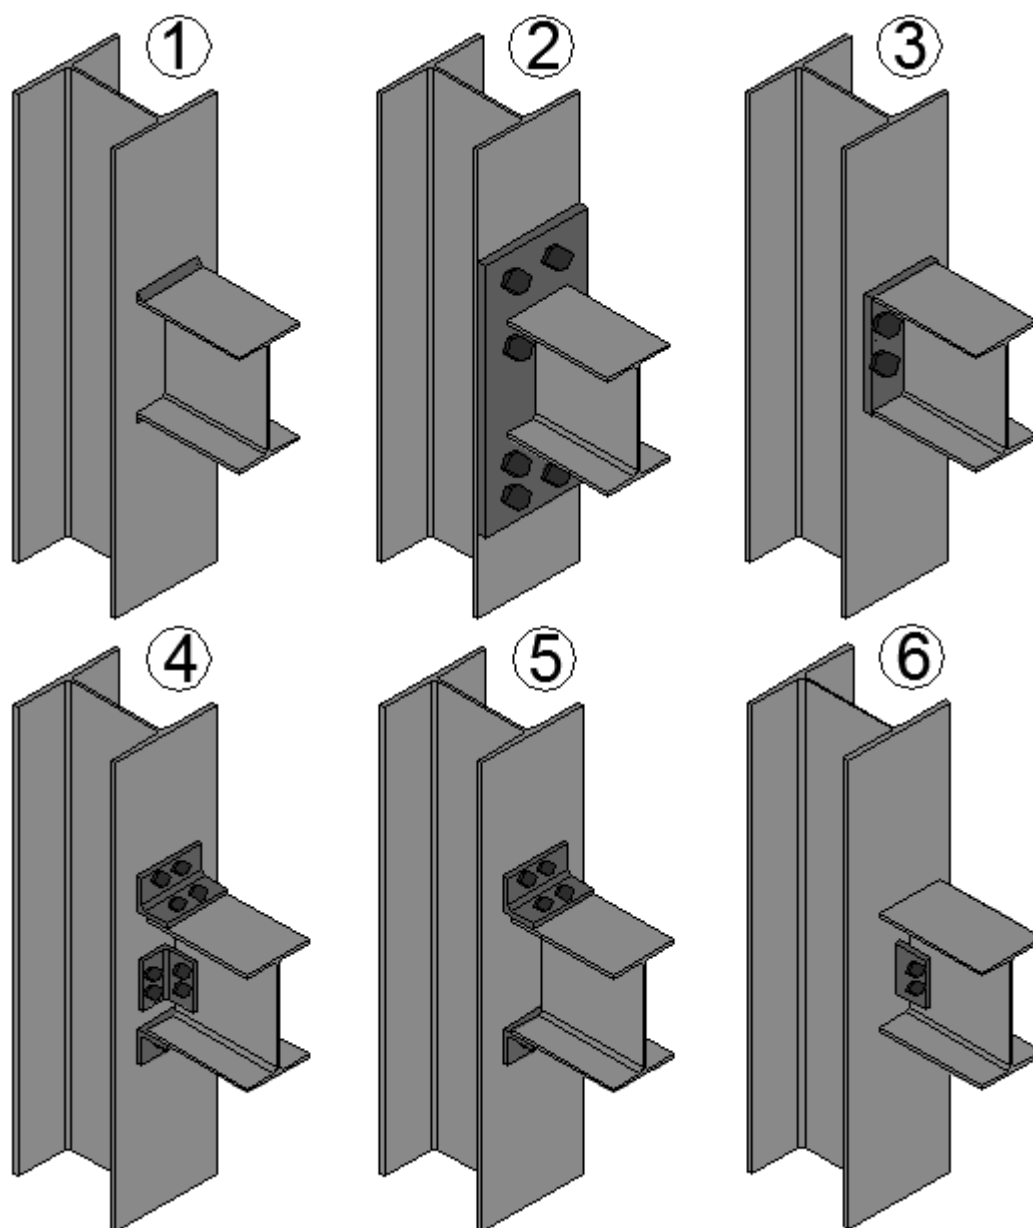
Tipologias correntes de ligações viga-pilar
